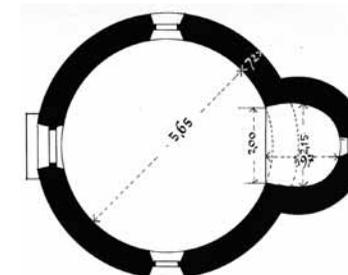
Grundriss Perschen, M 1:200. BDA Bayern.
